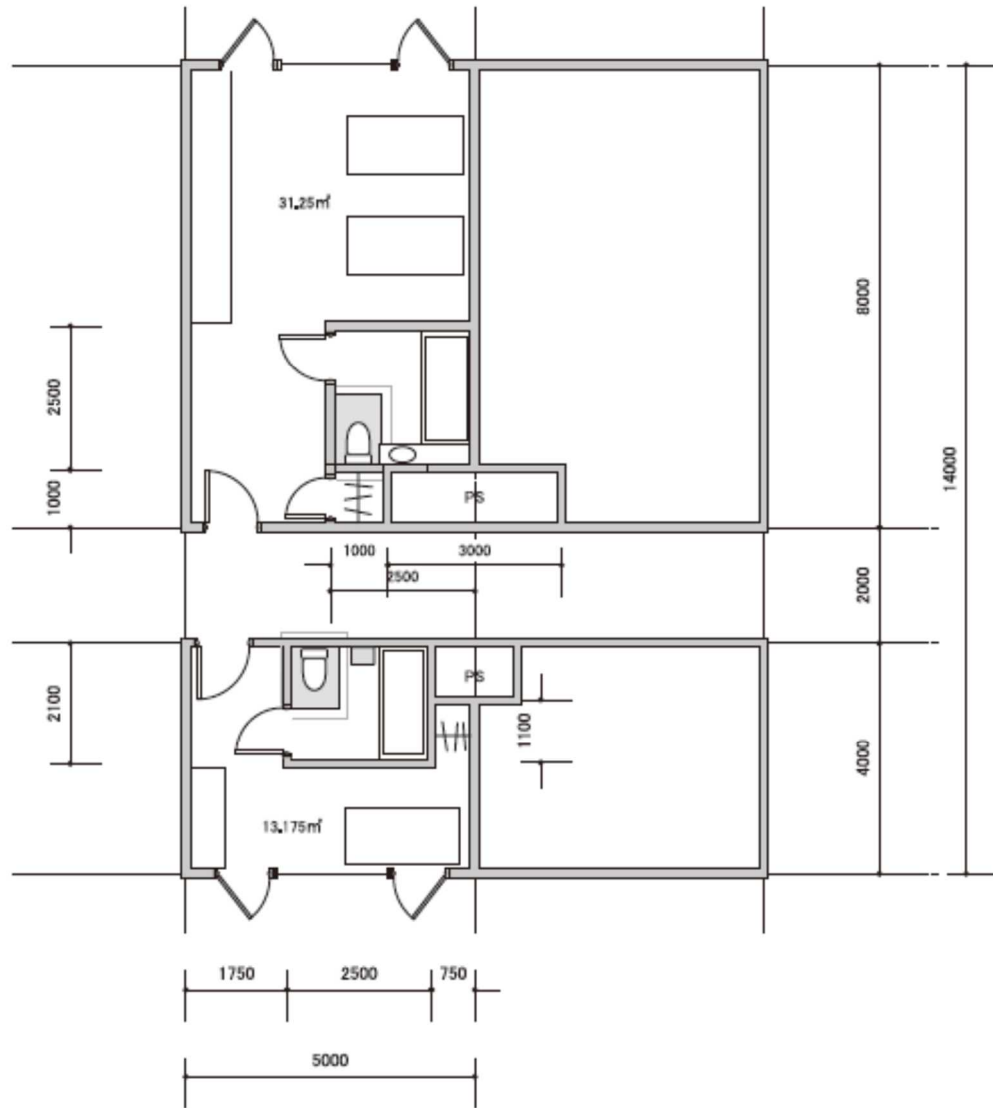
4 モデル建物法（シティーホテル等） 客室基準平面図
